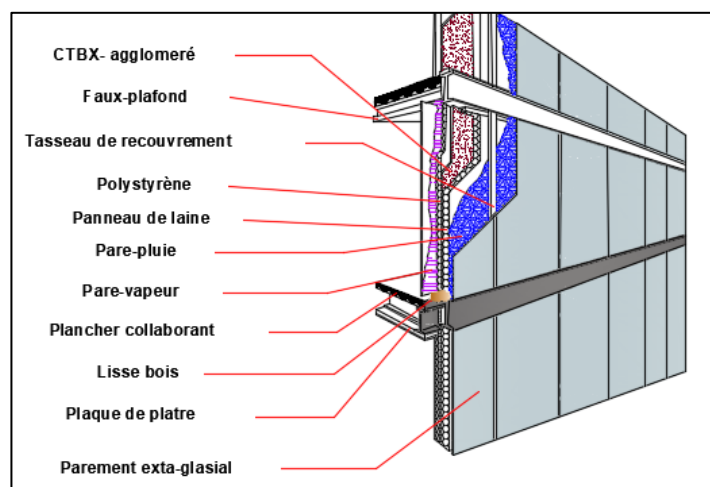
vue 3d de façade de mur rideau Source : auteurs
